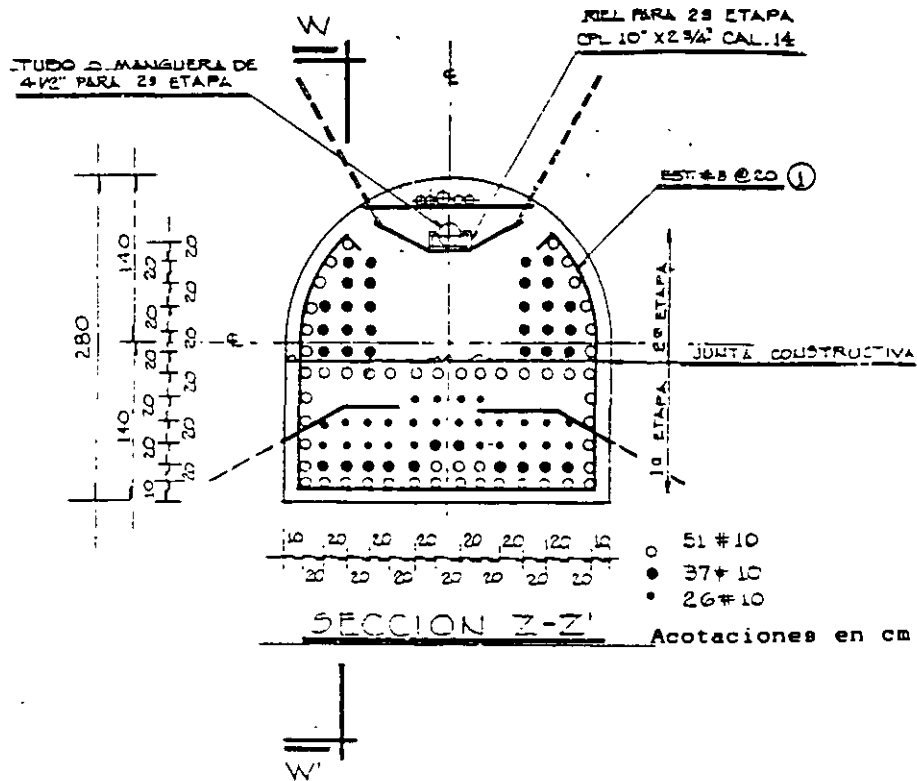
Sección de las trabes en galería, mostrando el armado.
